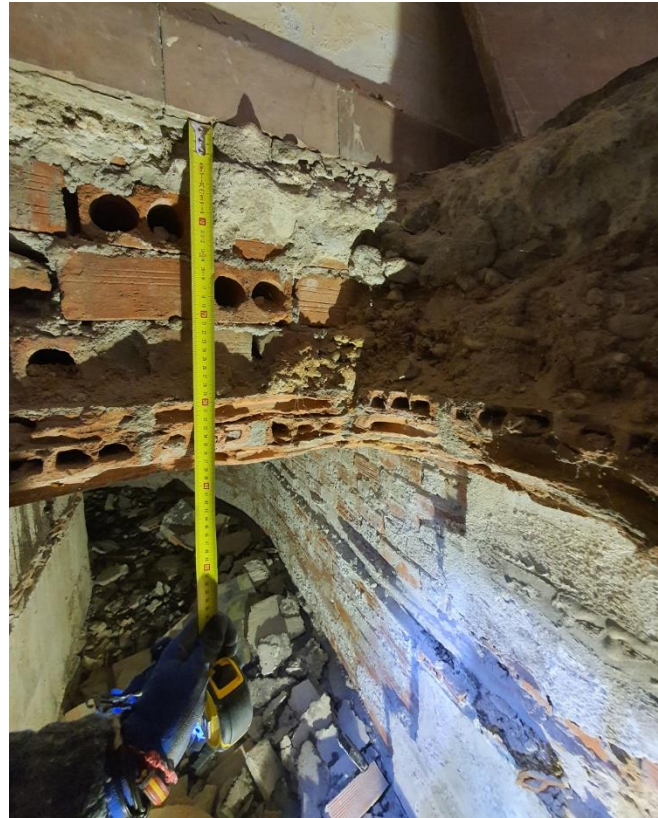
Detalle de la cata 10 INC. Caracterización del forjado del techo de las galerías.
